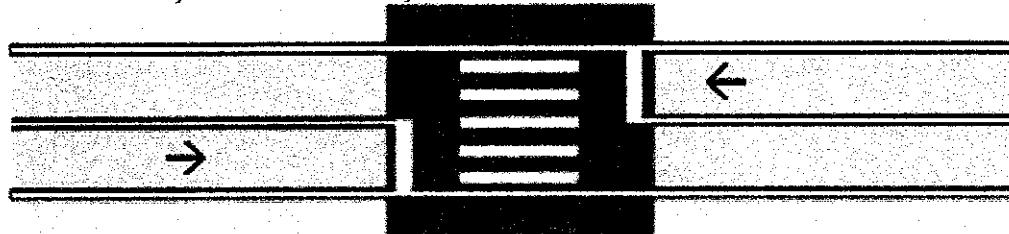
TRAVESSIAS EM PAVIMENTO DE CONCRETO
